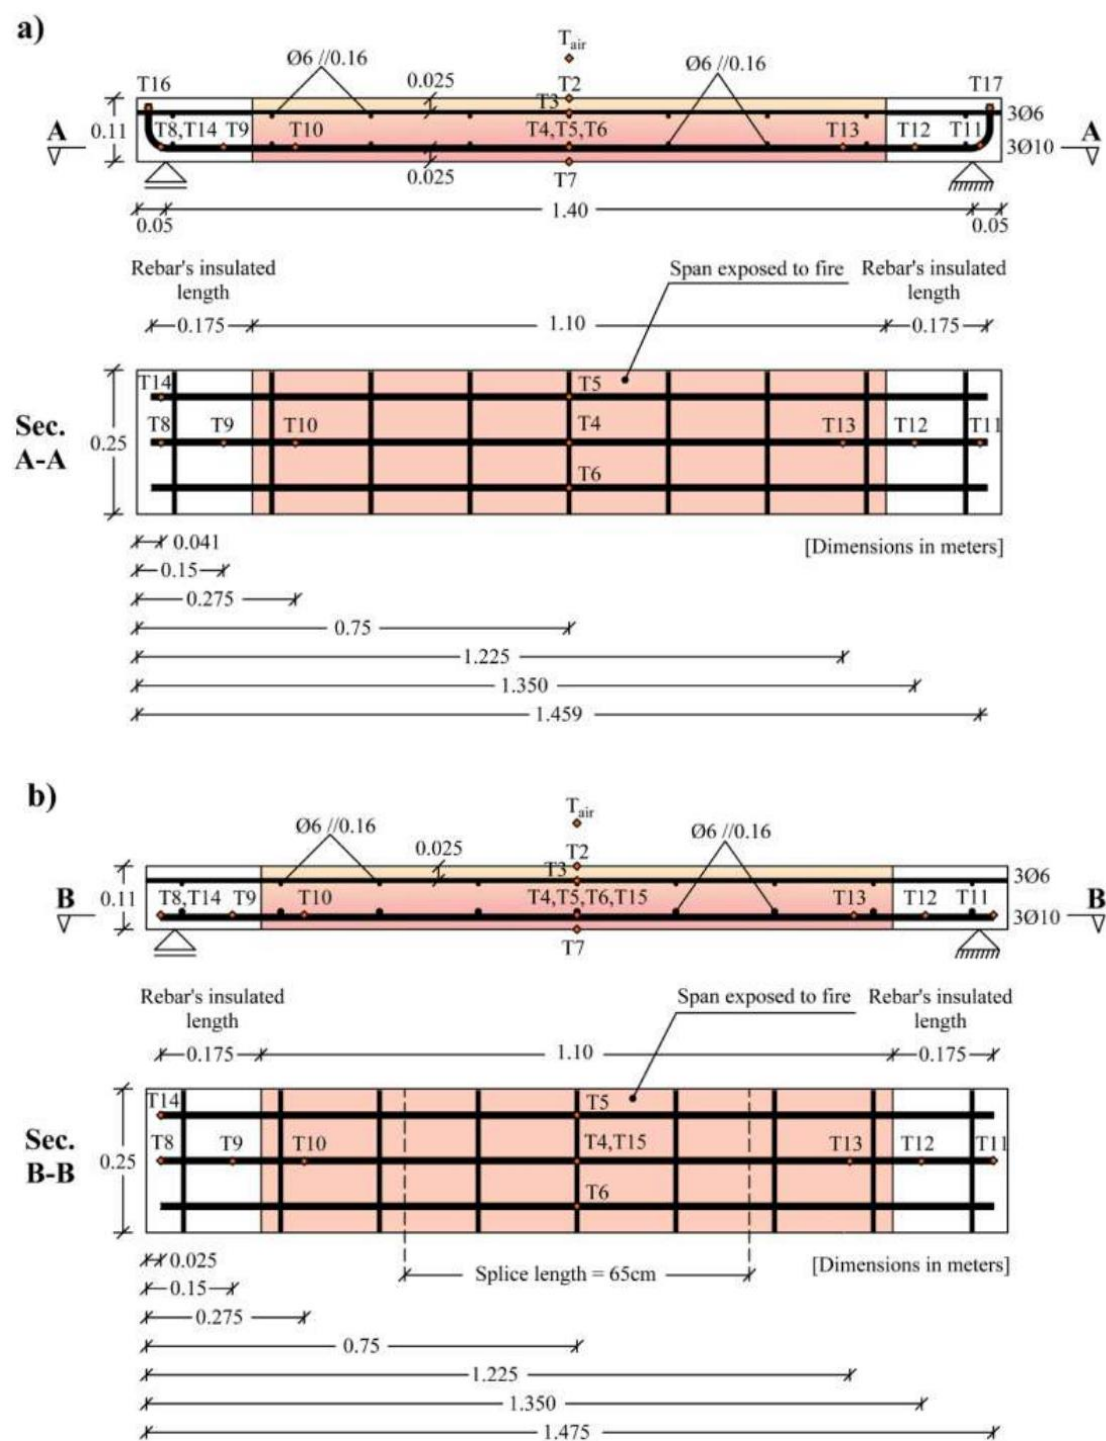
Distribuição do reforço e posição dos termopares: (a) faixa de laje RC C2.5; (b) faixa de laje GFRP-RC (dimensões em metros) (Rosa *et al.*, 2021).
